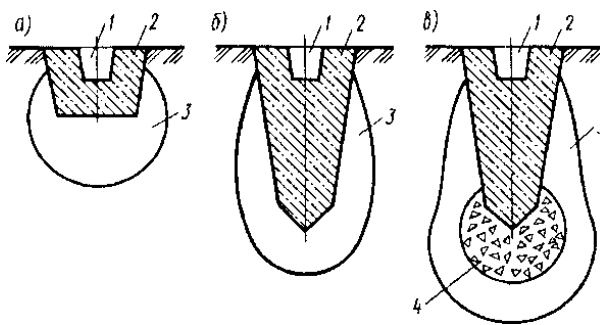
Схеми влаштування методом витрамбовування котлованів фундаментів: а – з плоскою підшвою; б – із загостреною підшвою звичайного типу; в – з розширеною основою: 1 – стакан для установки колони; 2 – фундамент; 3 – зона ущільнення; 4 – витрамбований жорсткий ґрунтовий матеріал.
